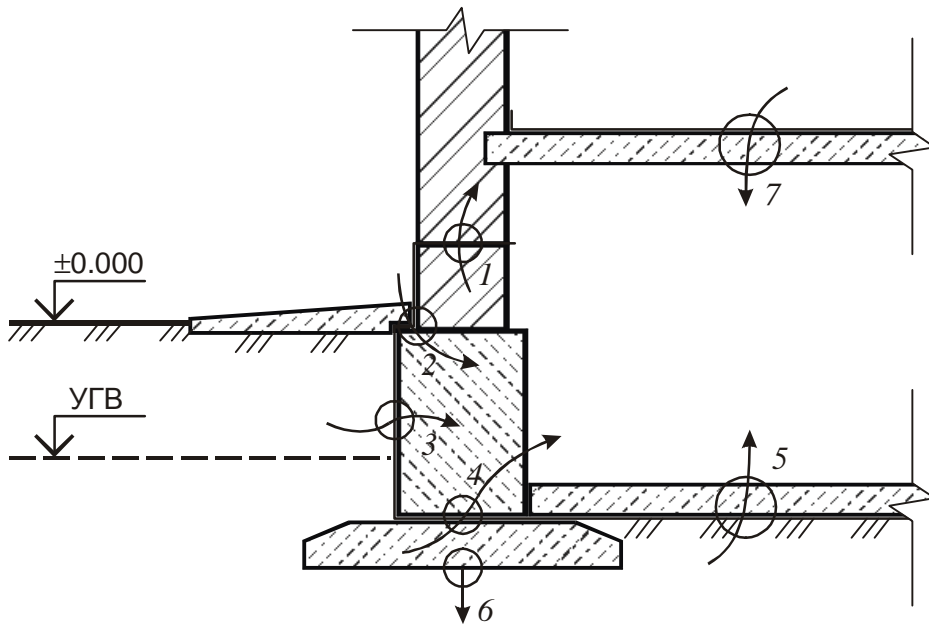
Характерные места повреждения гидроизоляции наземных зданий и сооружений: 1 – горизонтальная гидроизоляция стен; 2 – вертикальная гидроизоляция цоколя; 3 – вертикальная гидроизоляция стен подвала; 4 – горизонтальная гидроизоляция стен подвала; 5 – горизонтальная гидроизоляция полов подвала; 6 – зона застоя или притока воды; увлажнение и вымывание основания и т.п.; 7 – гидроизоляция перекрытий в санузлах
